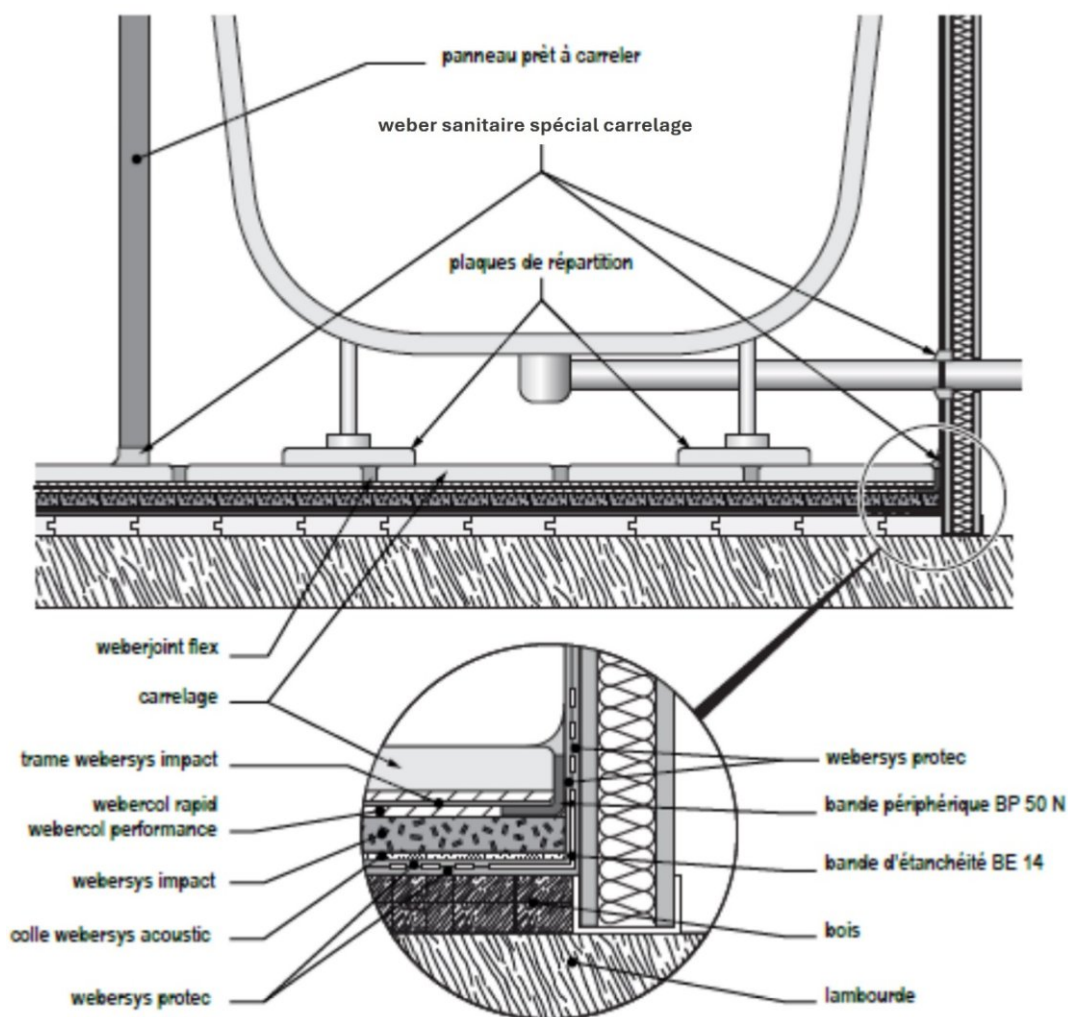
Traitement d'une baignoire avec allège sur support bois
